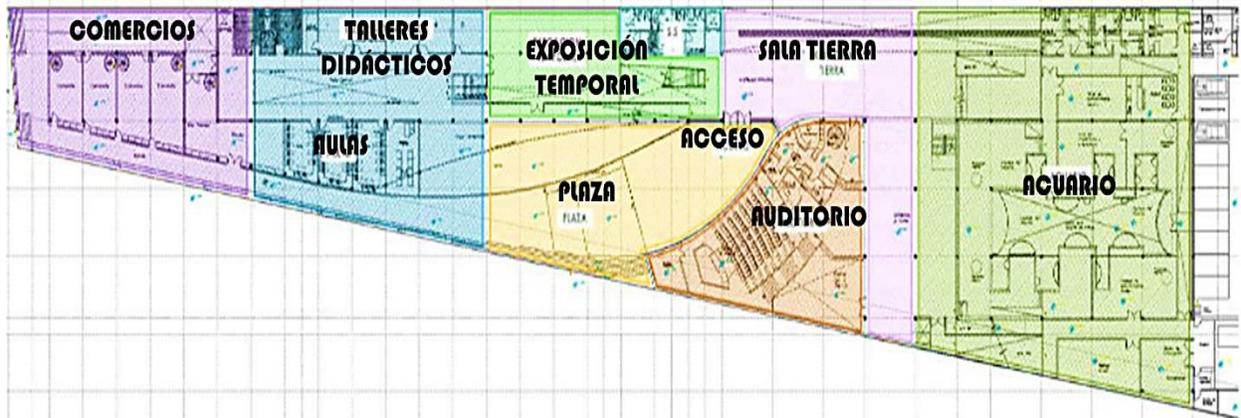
PLANTA ARQUITECTÓNICA DE CARACOL, MUSEO DE CIENCIAS Y ACUARIO. Planta donde se vislumbran los espacios principales. Fuente: www.caracol.org.mx
